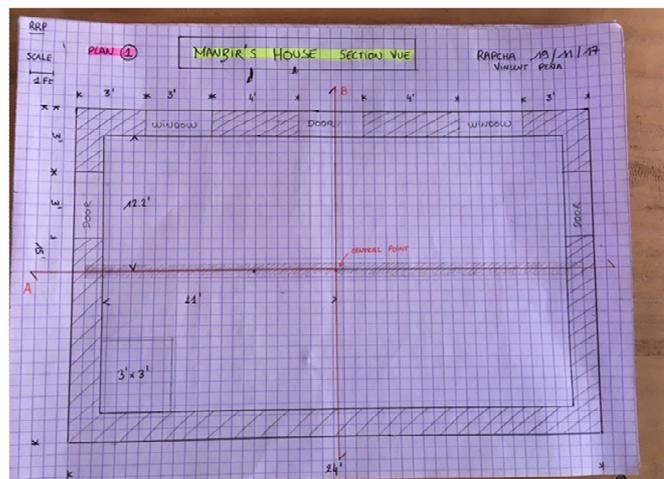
Exemple de plan dessiné avec les ouvriers - 12/2017
